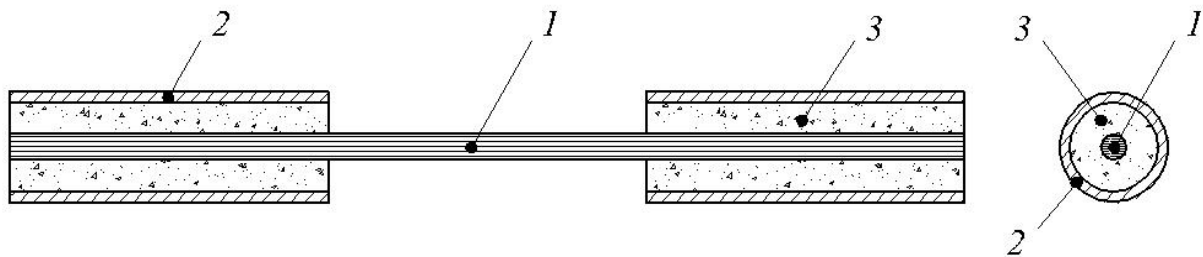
Общий вид образцов с анкерным захватом [2]:
